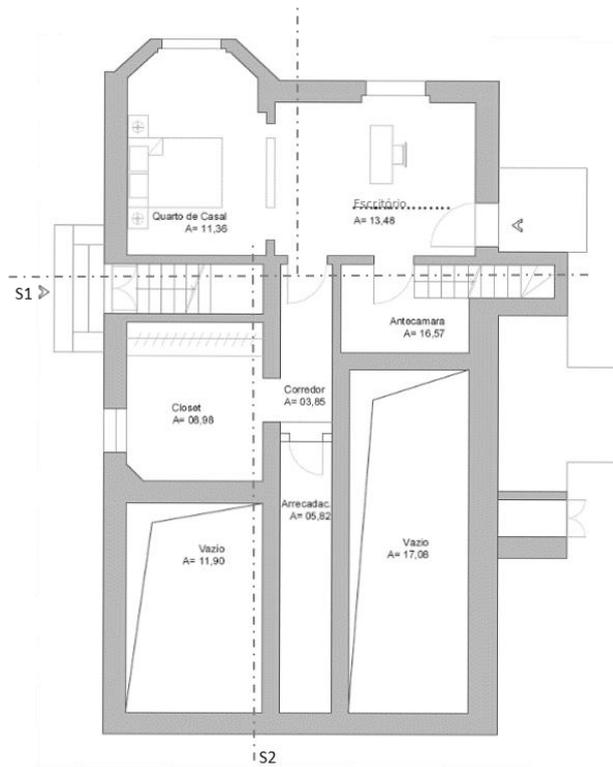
13 - Planta da cave existente, sem escala (Fonte: de autor).
